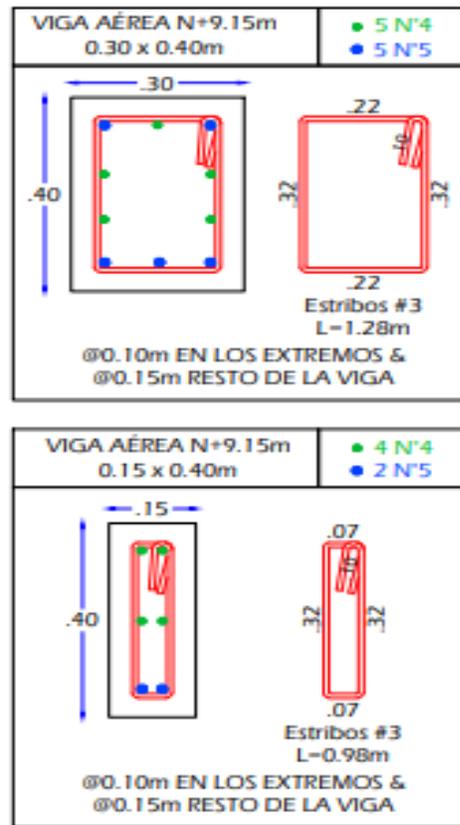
Estribos de vigas principales y vigas secundarias en el plano estructural.
